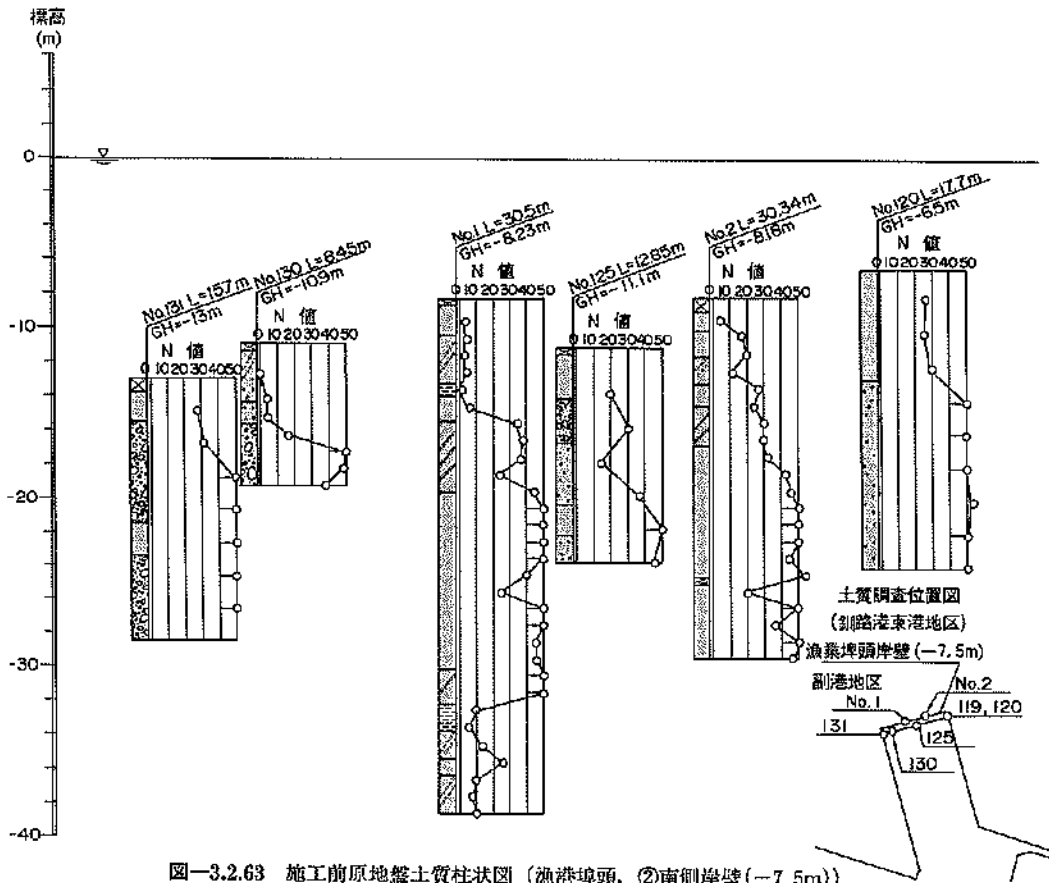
施工前原地盤土質柱状図 (漁港埠頭, ②南側岸壁(-7.5m))
